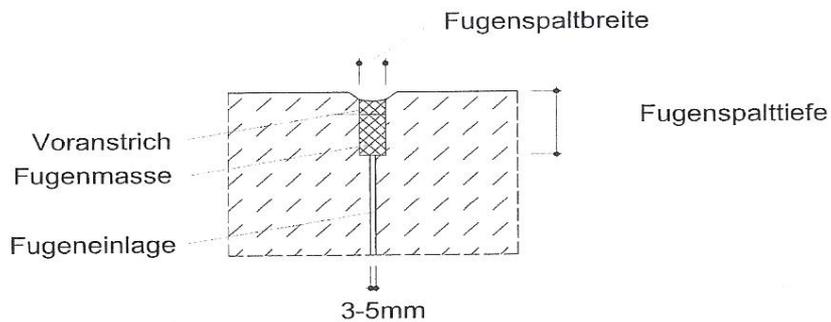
Ausbildung einer Gleitfuge in Betondecke
